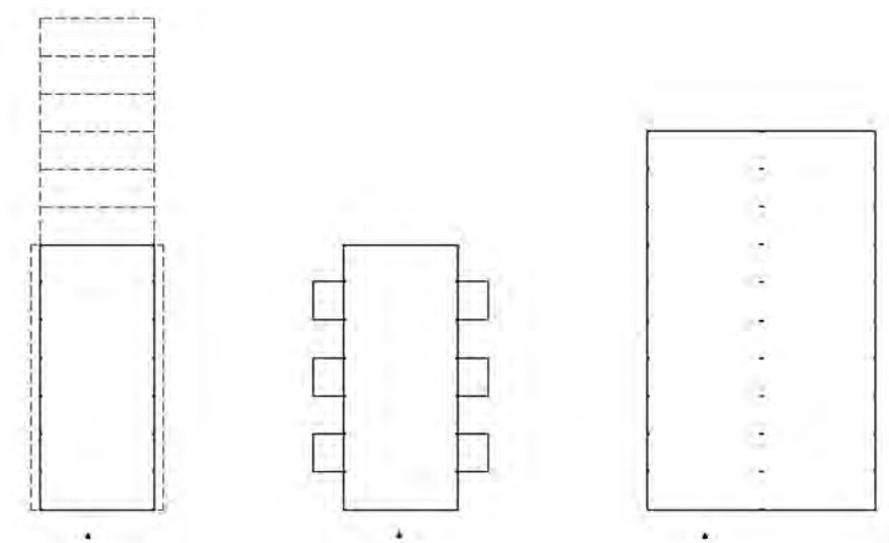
Grundrißvarianten der Leichtbauhalle von Röder, drei Beispiele. Maßstab 1:1000. *Eigene Darstellung.
